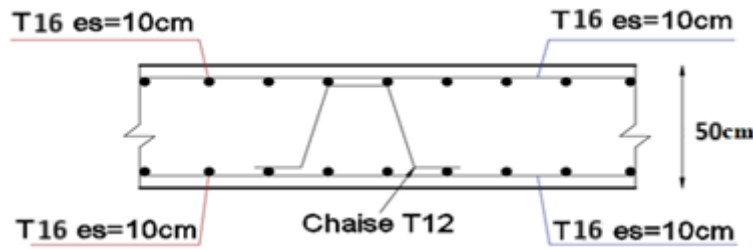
Schéma de ferrailage de la dalle du radier.
